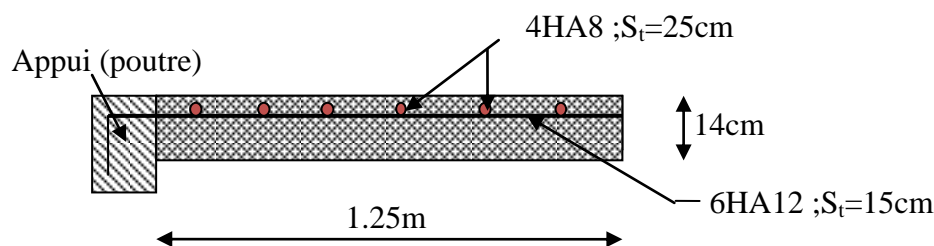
schéma de ferrailage de la dalle pleine
